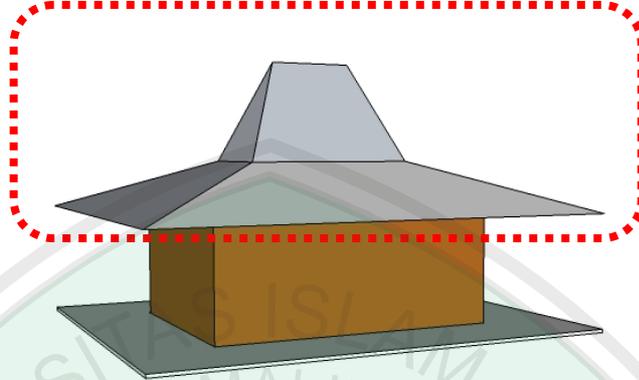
Penggabungan struktur bangunan lama dan baru
